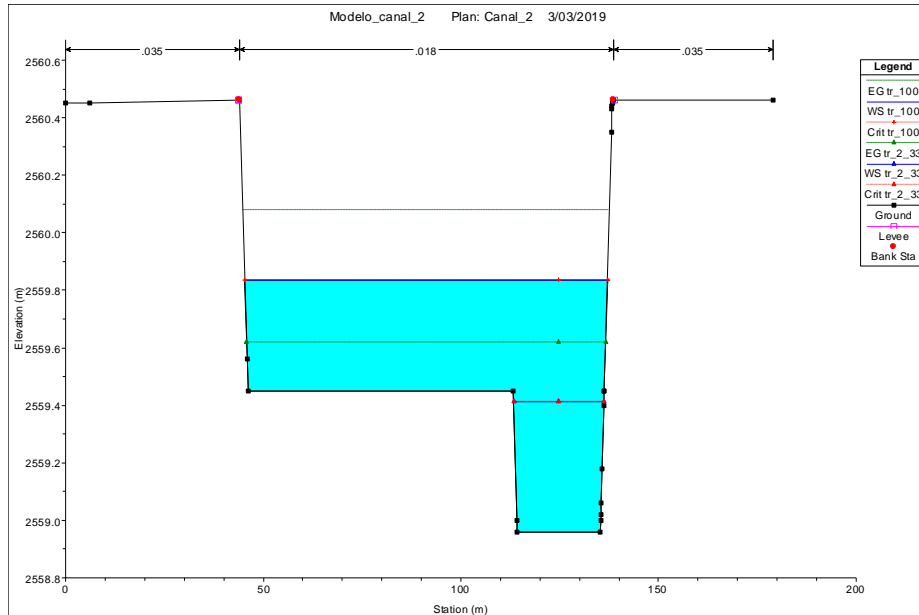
Sección transversal dominante cargado al talud derecho - segundo canal
